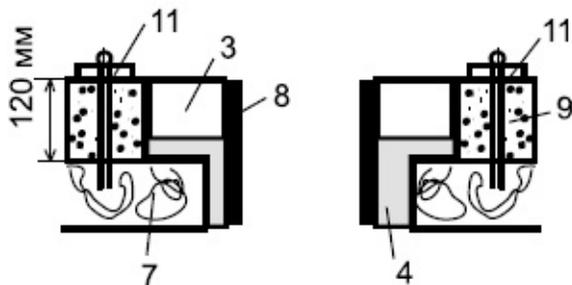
Способ кладки дымовых труб (продолжение): 1 – распушка надпотолочная; 2 – дымовая труба над перекрытием; 3 – дымовая труба под перекрытием; 4 – теплоизоляция термостойкая; 5 –
